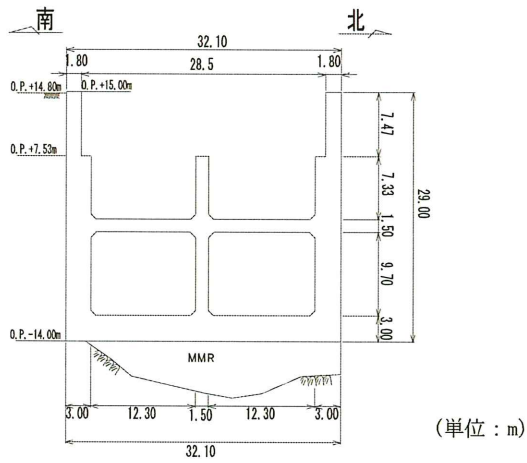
第 3 号機海水ポンプ室断面図 (B-B 断面)
